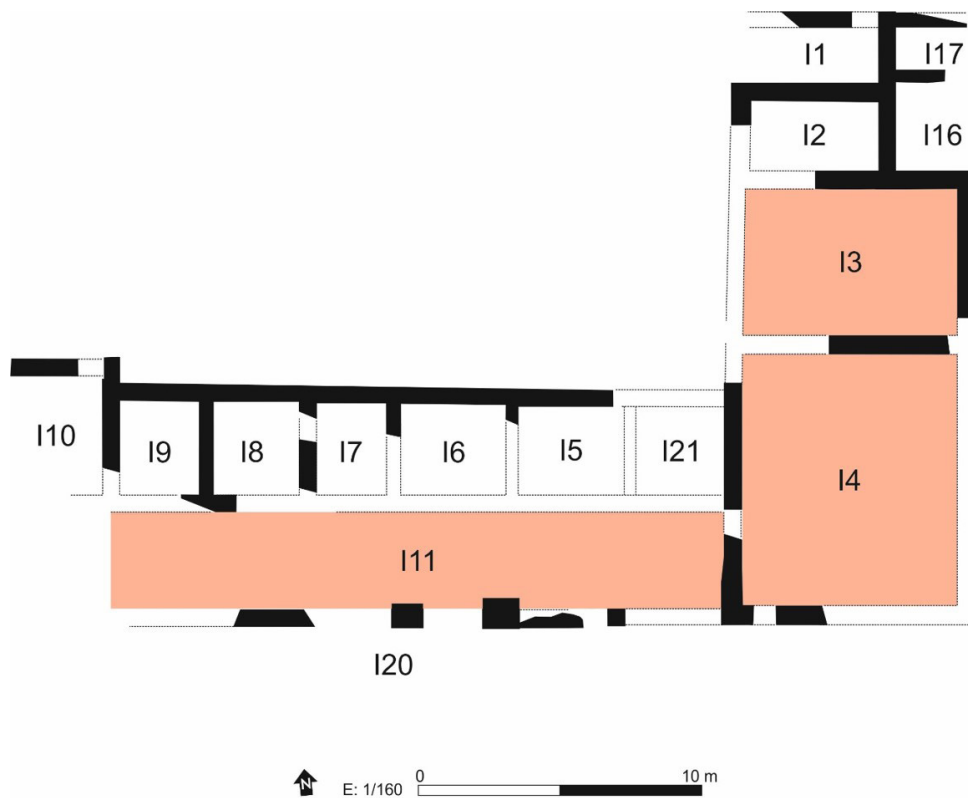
Planta de la vil·la construïda entorn els anys 60-70 dC.
